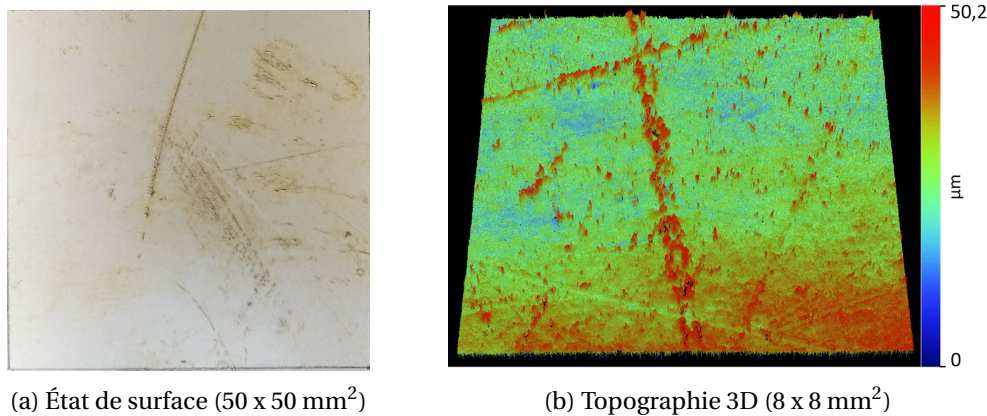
Surface de la peau coffrante RPa1'c après utilisation sur site.
